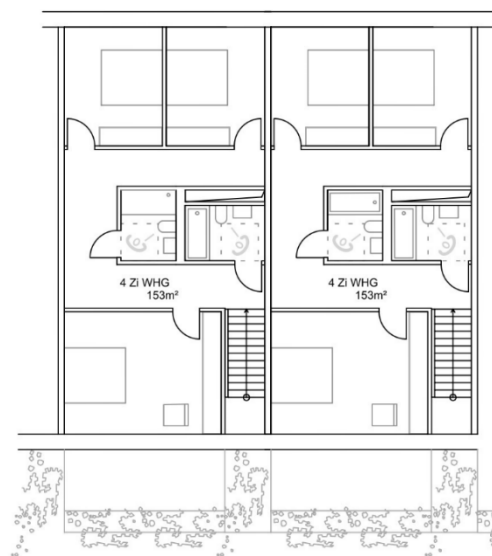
| Quartier 06: Beispielgrundriss Maisonette (oben)
